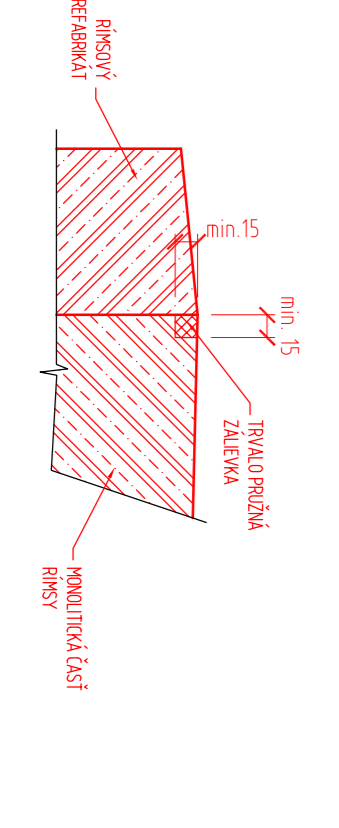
DETAIL TESNENIA ŠKÁRY POZDĽ Ž OBRUBNÍKA
